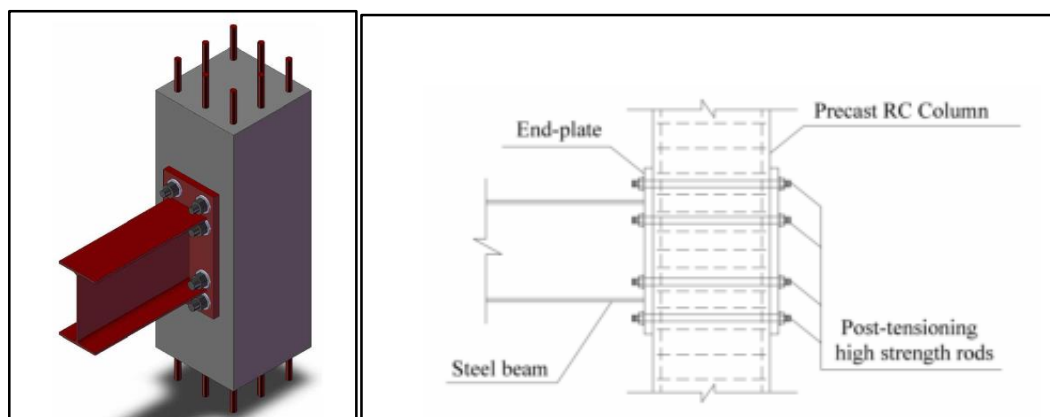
Conexión Híbrida Viga-Columna Fuente: Wu [6]
